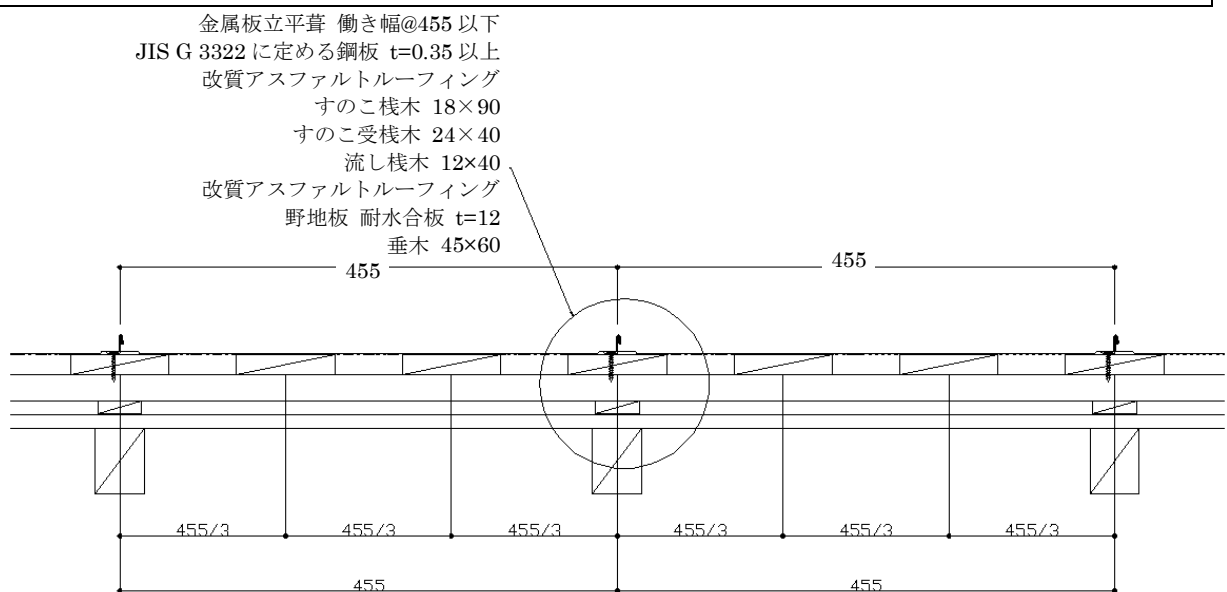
立平葺 一般部の例 (図中の数字の単位は mm)
